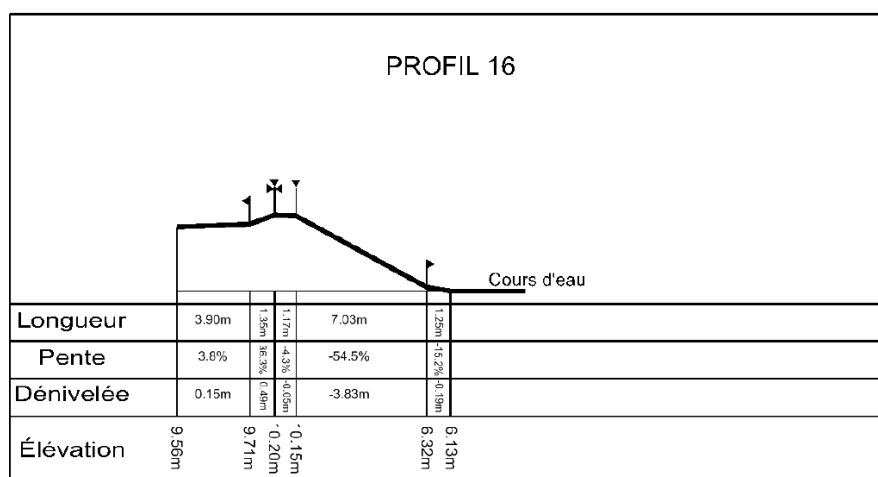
Exemple d'un profil transversal d'un transect d'un OPI.
